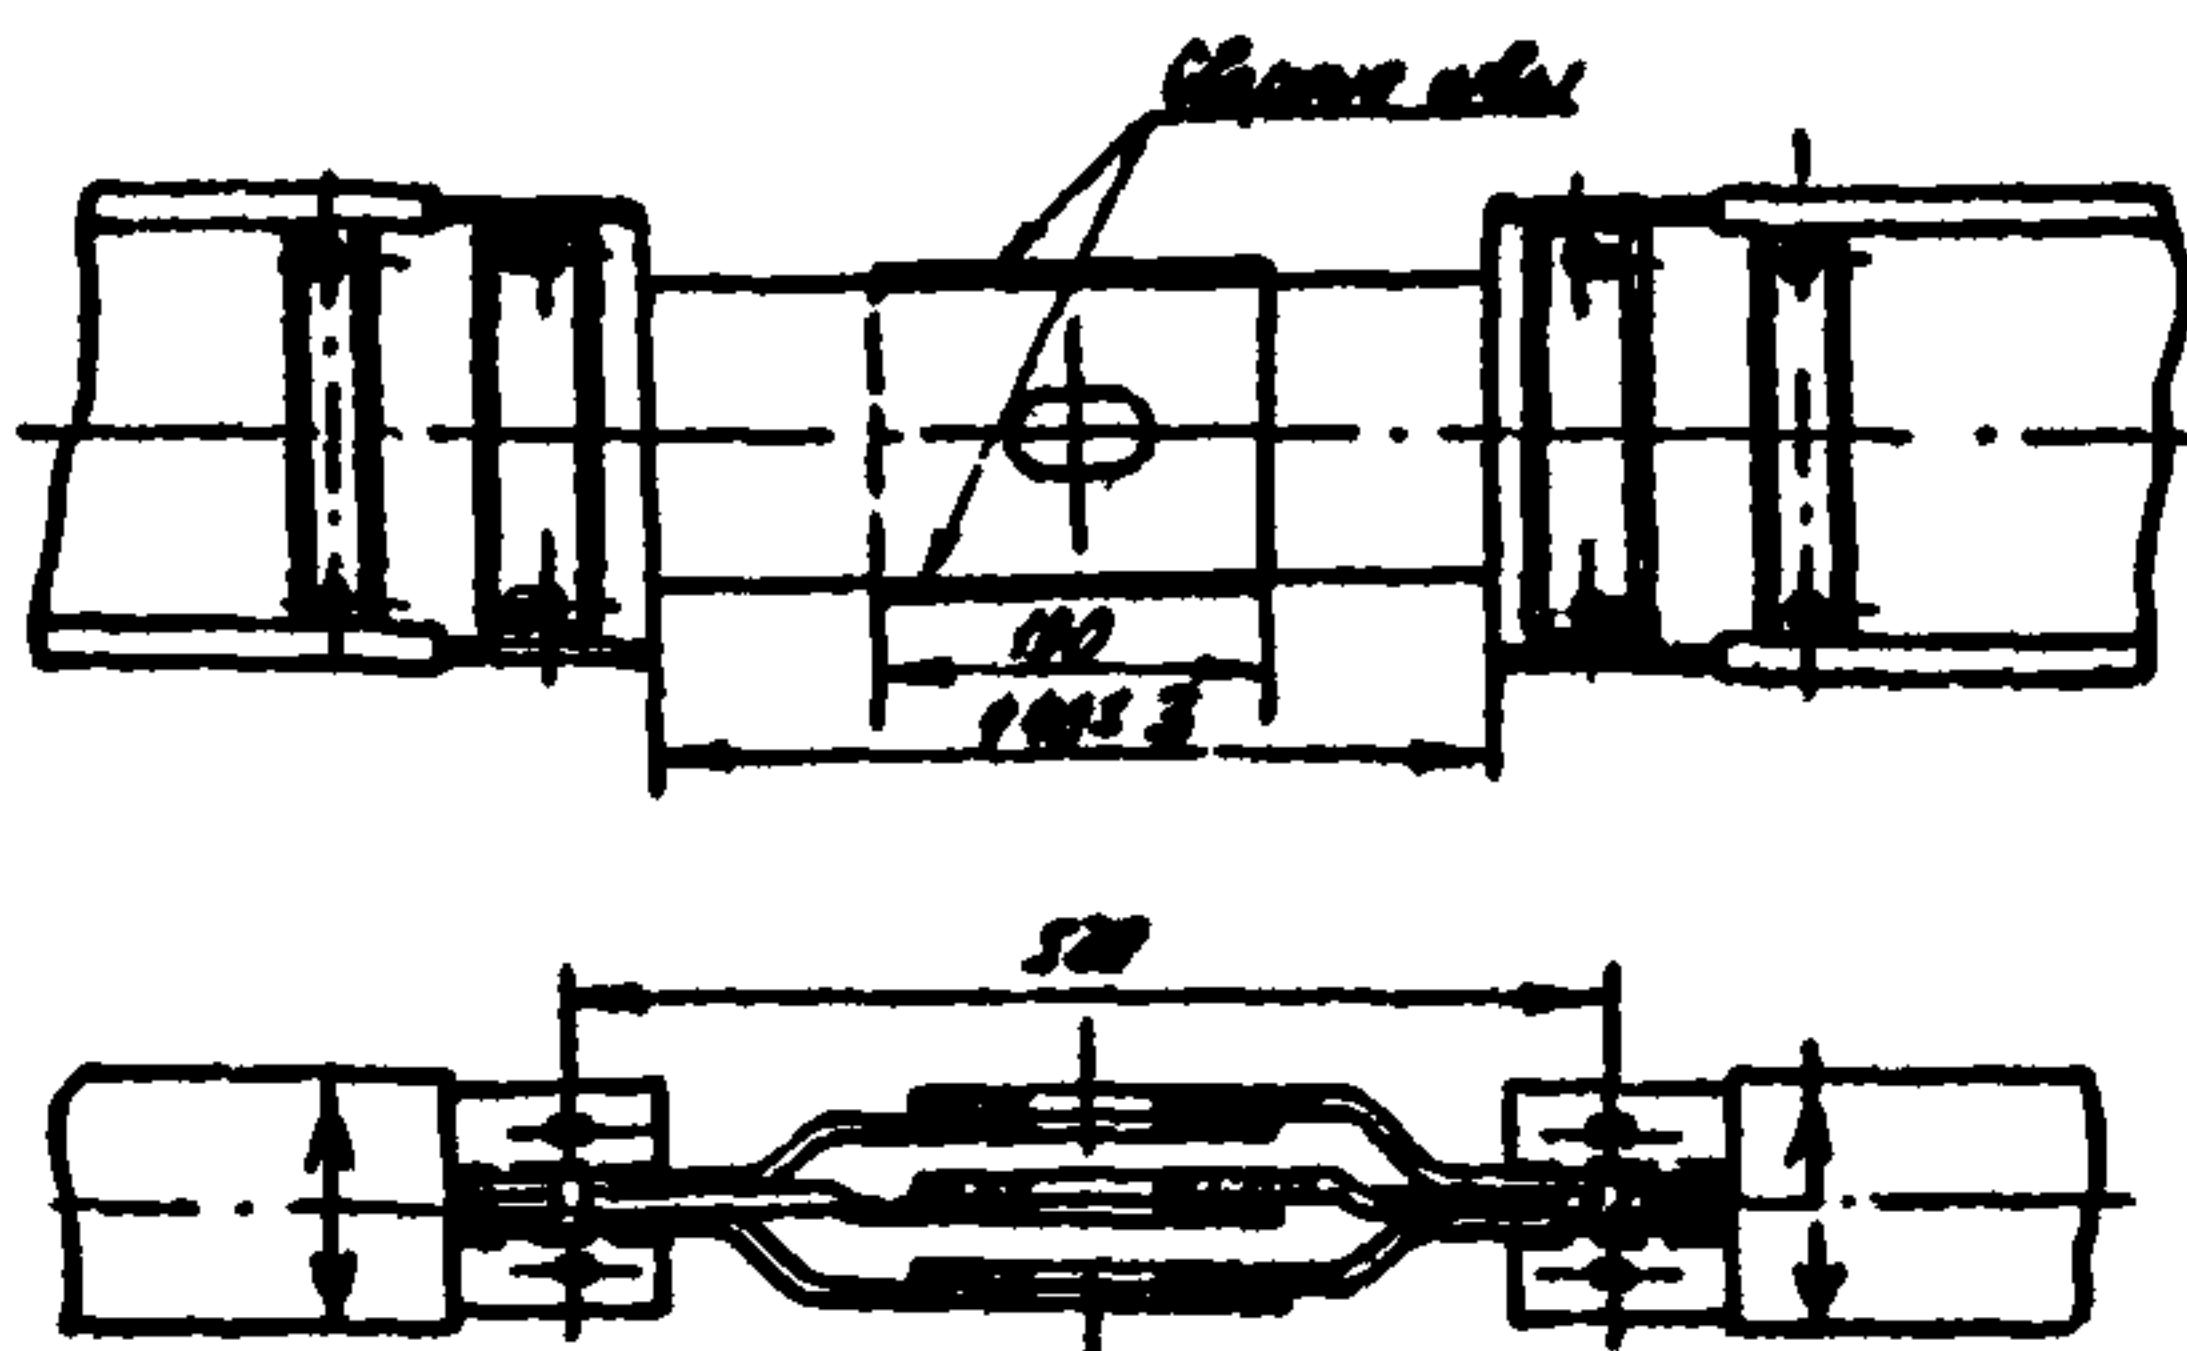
Расположение шин при сварке секций шинопроводов
